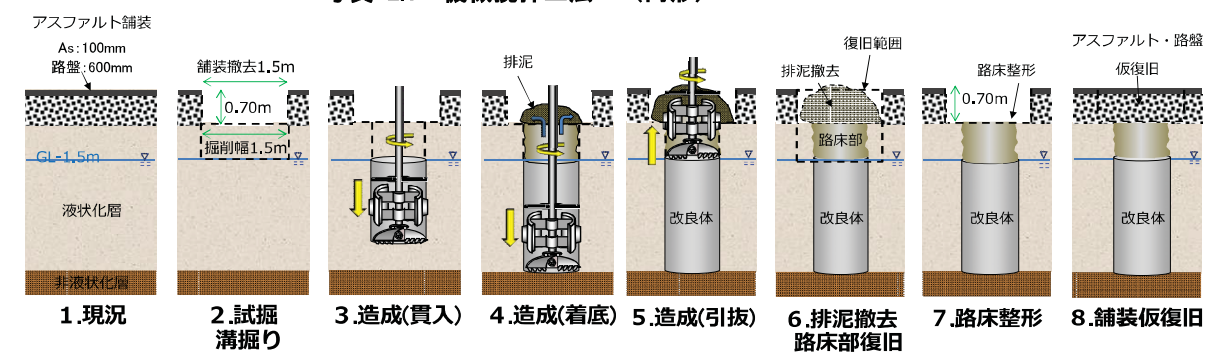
機械攪拌工法の施工手順 (道路部を標準)
